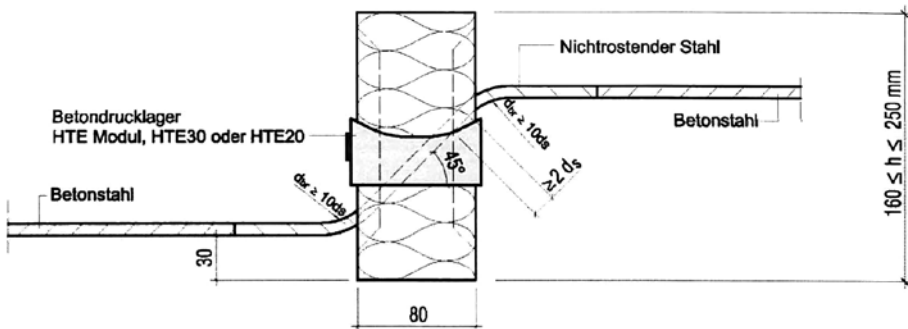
Schöck Isokorb Typ Q¹⁾ mit Betondrucklager
